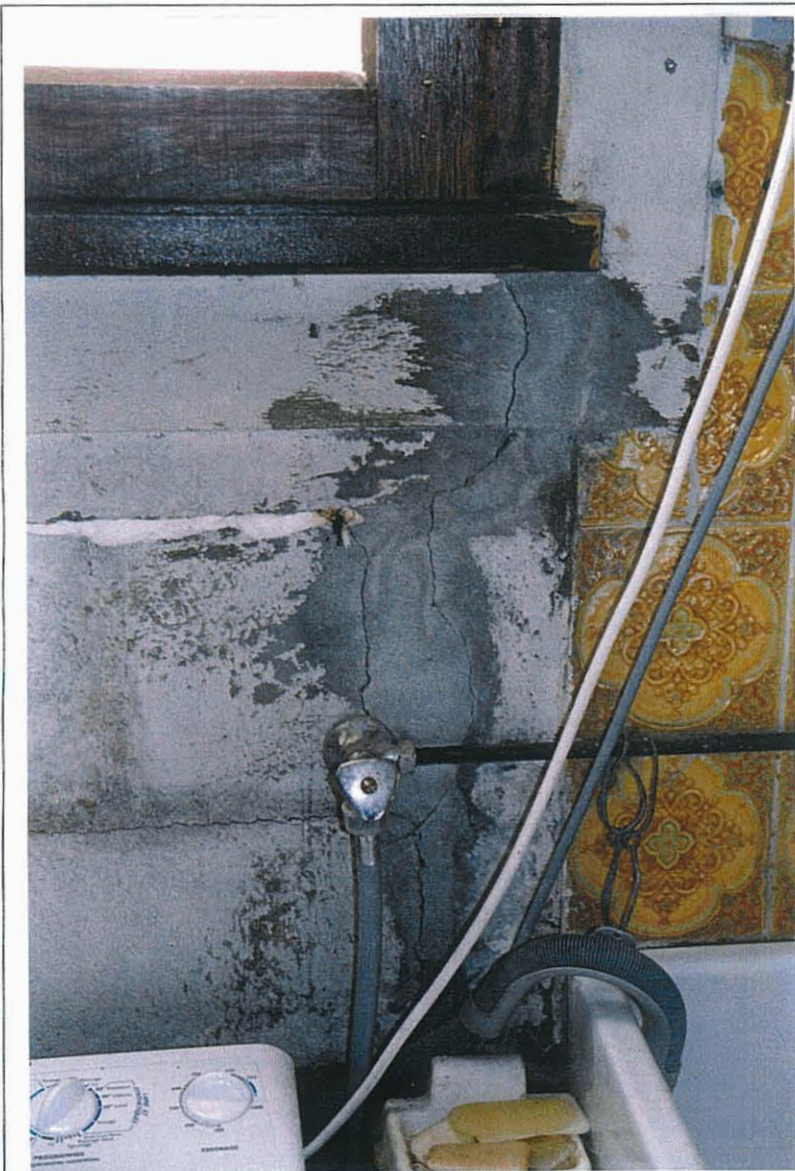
Lézardes sous fenêtre façade S-W.
